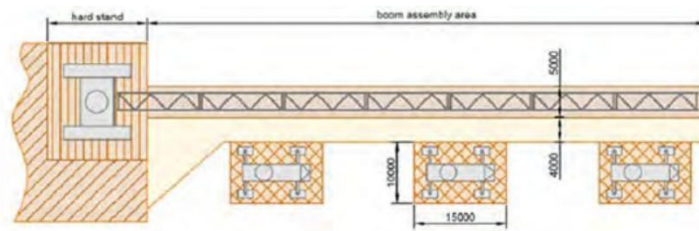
Schema di assemblaggio di una gru a traliccio.
